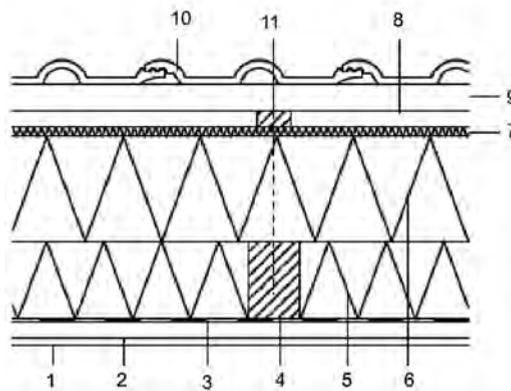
Полная теплоизоляция поверх стропил с помощью теплоизоляционных древесно-волоконных плит: 1 — облицовка из гипсокартона; 2 — обрешетка/установочная поверхность; 3 — пароизоляционная прокладка; 4 — стропила; 5 — теплоизоляционный слой; 6 — теплоизоляционные древесно-волоконные плиты (например, Gutex); 7 — диффузионно-проницаемые плиты для обшивки стен и крыш (DWD-Platte, diffusionsoffene Wand- und Dachplatte); 8 — противовесная обрешетка; 9 — обрешетка крыши; 10 — кровельное покрытие; 11 — крепление древесно-волоконной плиты (например, шурупам по дереву)
